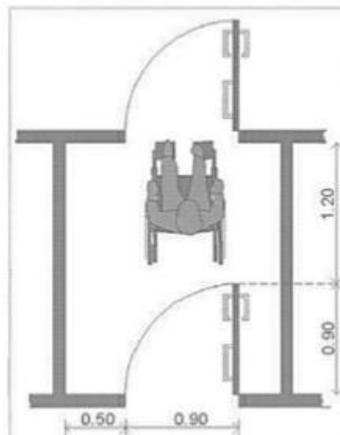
Parámetros arquitectónicos y de seguridad. Apertura y cierre de puertas
